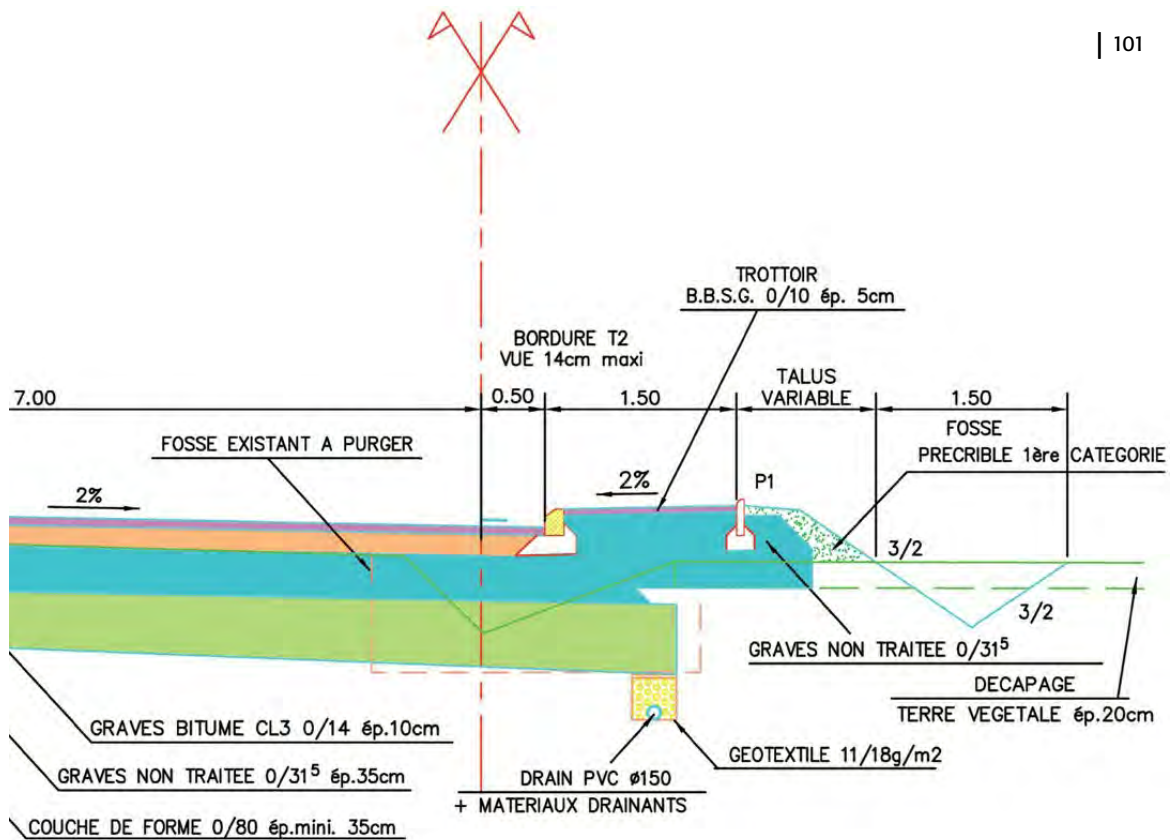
Carrefour plan ordinaire – Profil en travers type. (Voir p.74-75)
